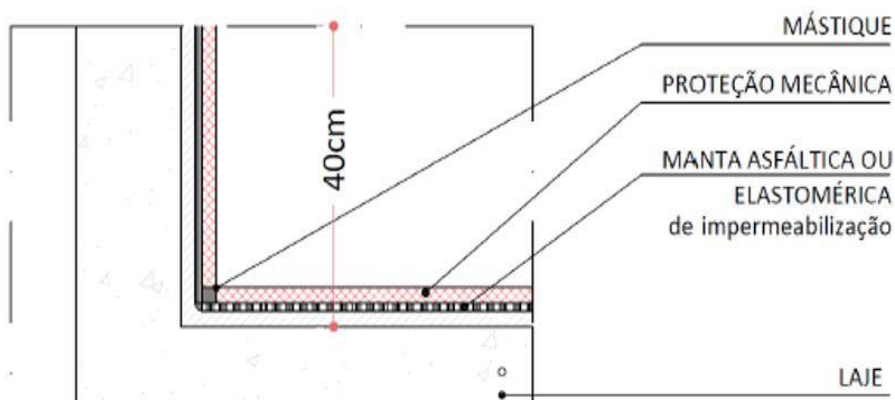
Detalhe de como deve ser feita a Impermeabilização + Proteção mecânica de Lajes de Cobertura
